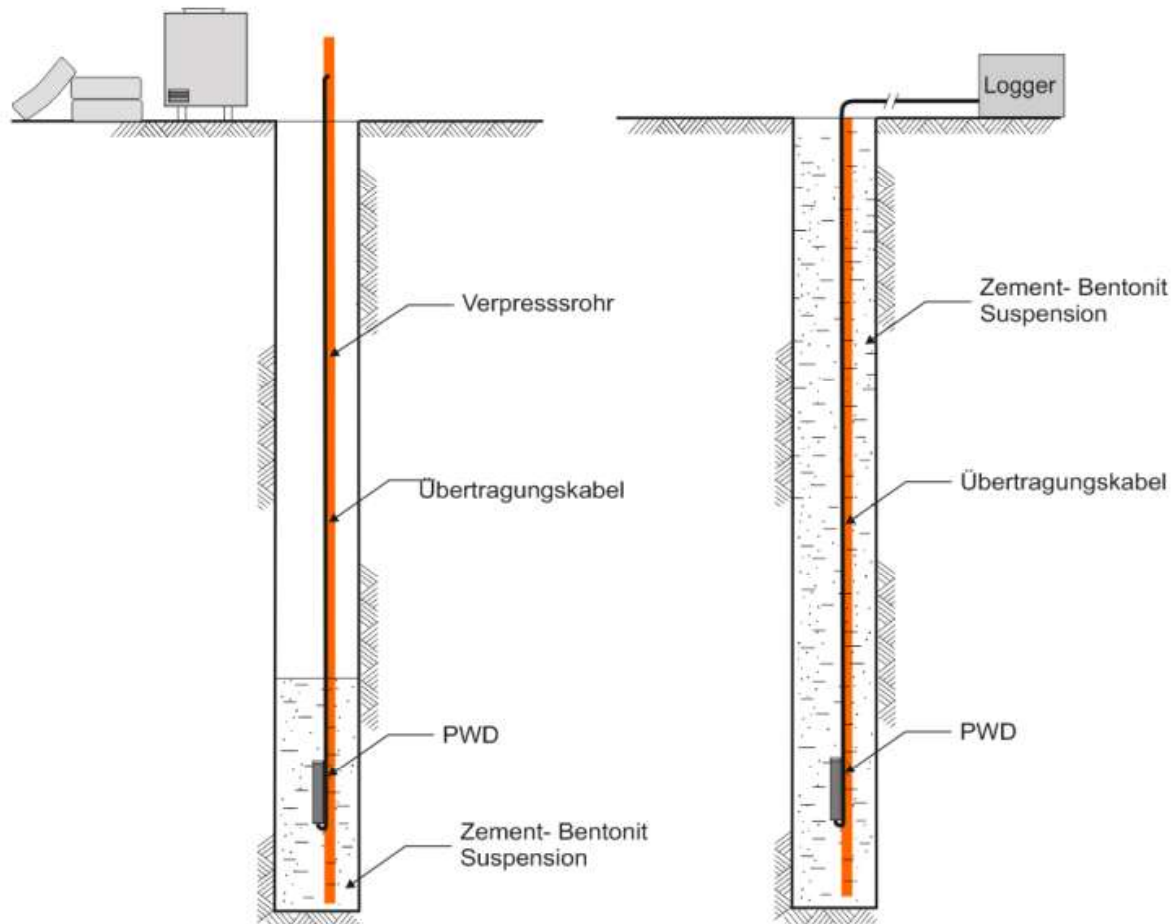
Fully-grouted Bohrlochausbau mit Verpressleitung
